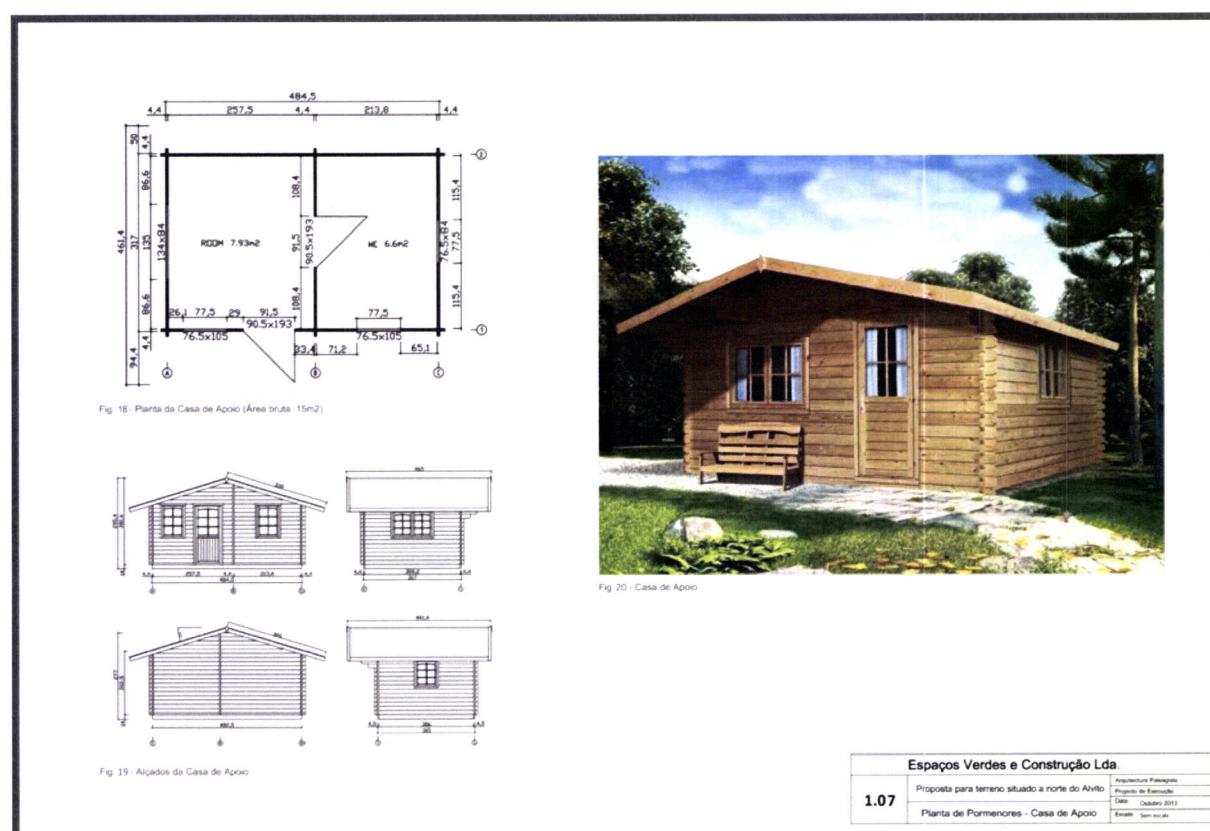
Peça Técnica relativa à Planta de Pormenores - Casa de Apoio tipo
